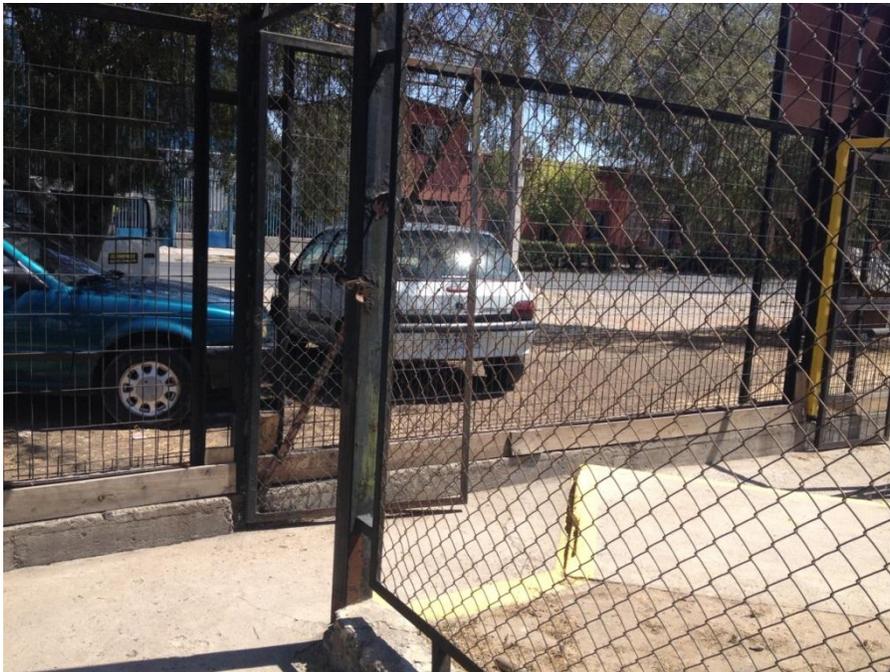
PUESTO N° 3 CIERRO PERIMETRAL REJA
